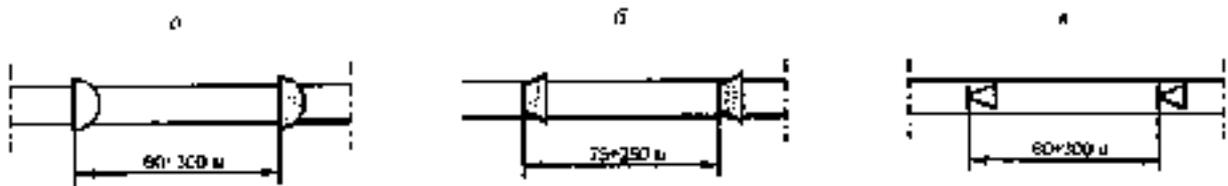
Схемы установки заслонов в выработках, оборудованных ленточными конвейерами
